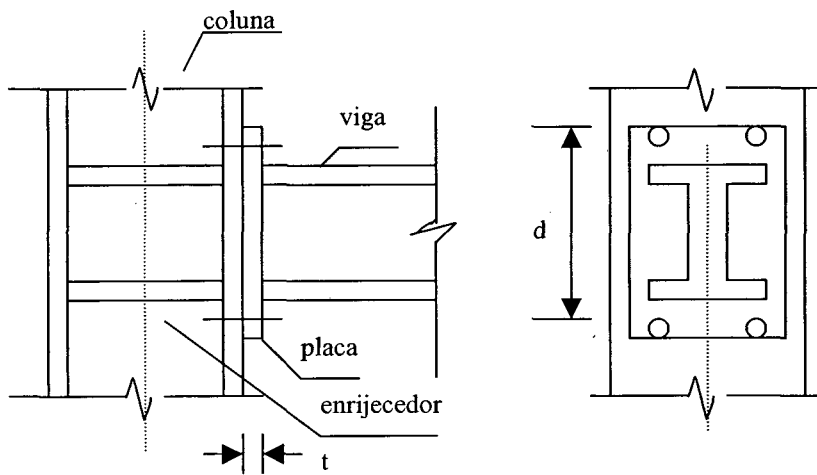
Típica conexão viga-pilar metálica “end plate with stiffeners”.
